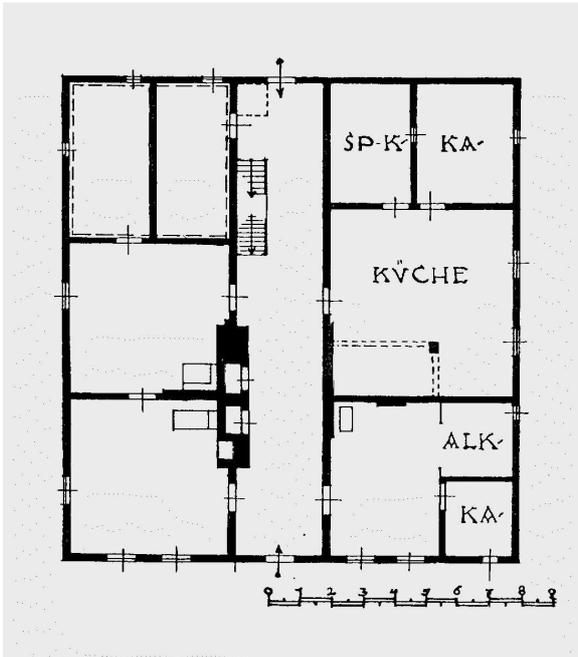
Grundriss des Lehnshulzenhauses Hohensaaten, erbaut 1817
